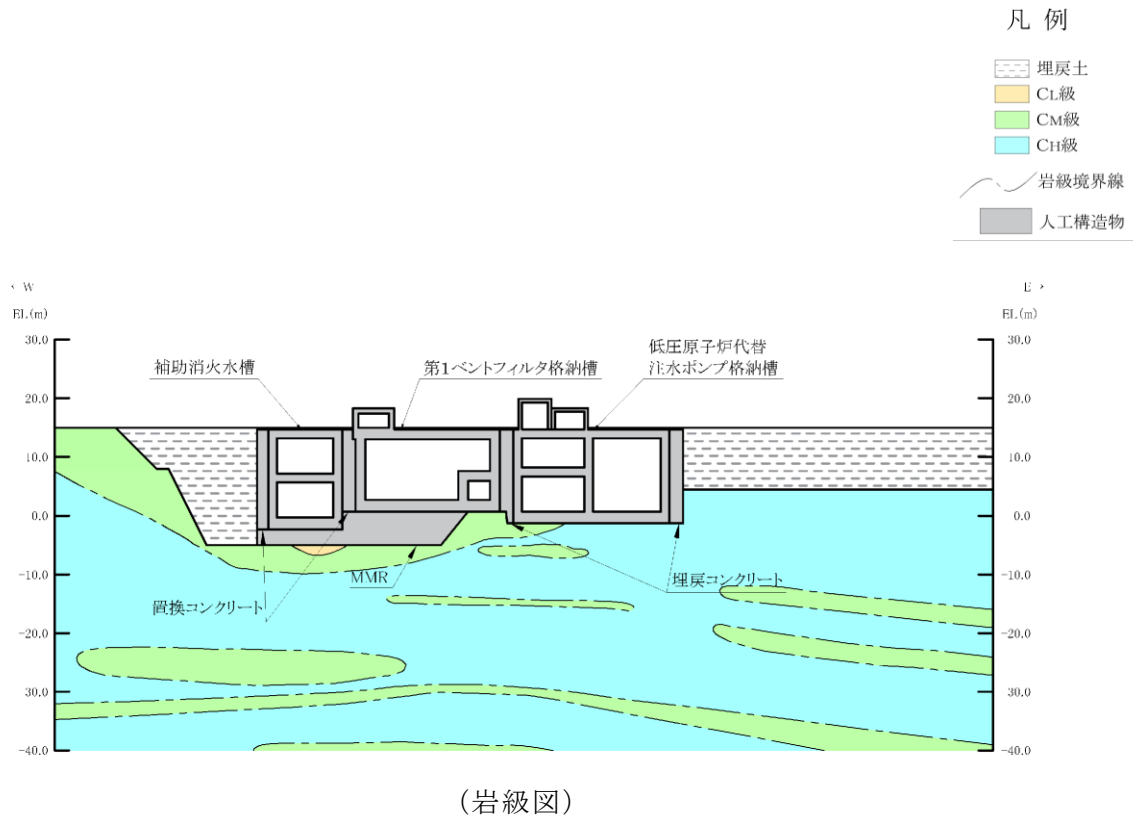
低圧原子炉代替注水ポンプ格納槽 評価対象断面図 (C-C 断面)
